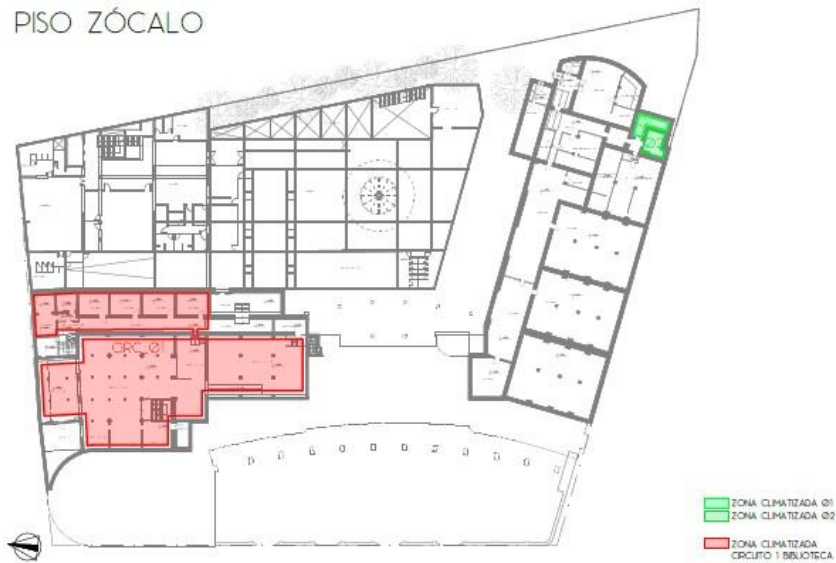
Planta esquema zonas climatizadas Piso Zócalo.
